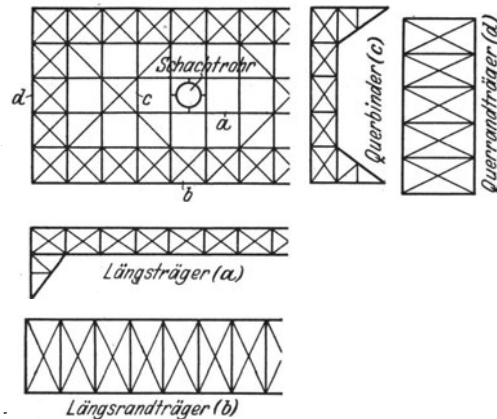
Schema eines eisernen Druckkastens, Draufsicht und Schnitte.
